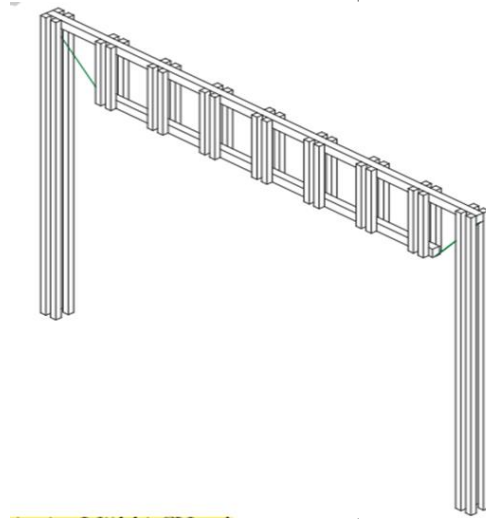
Poutre préfabriquée - Viikki Church. Illustration : Mathieu Sudres
